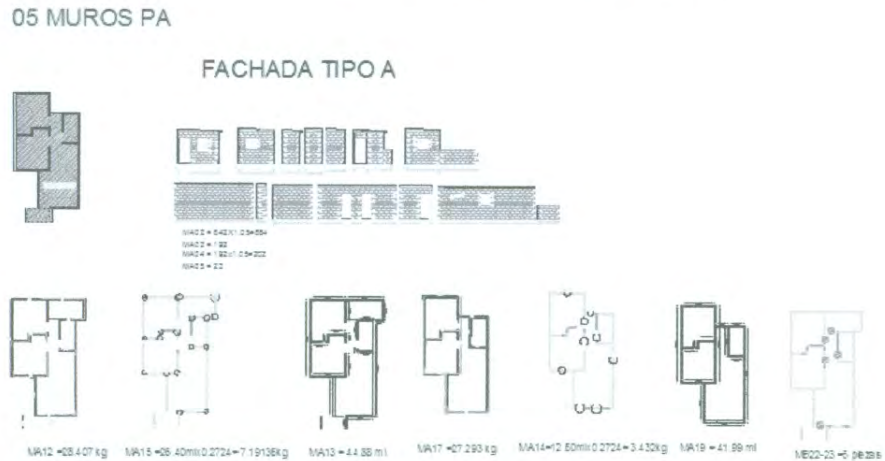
Plano de muros en planta alta para cubicar las cantidades de insumos
